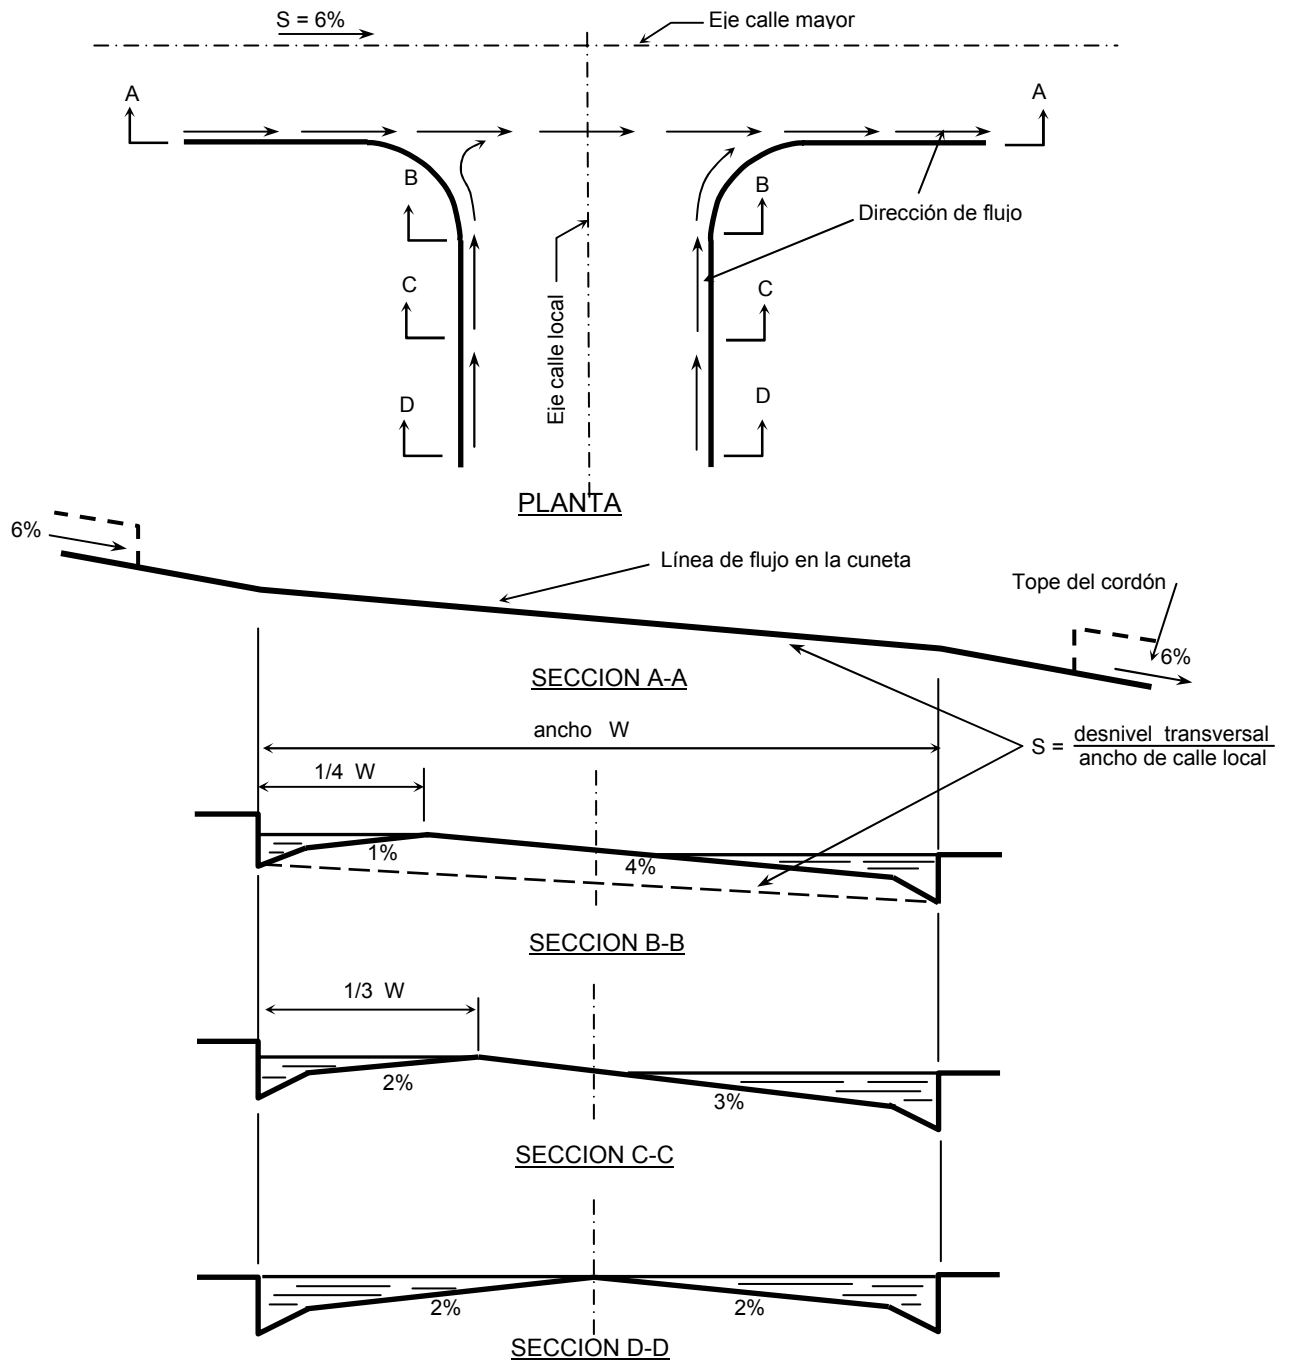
Construcción de una intersección típica entre una calle menor y otra mayor.
